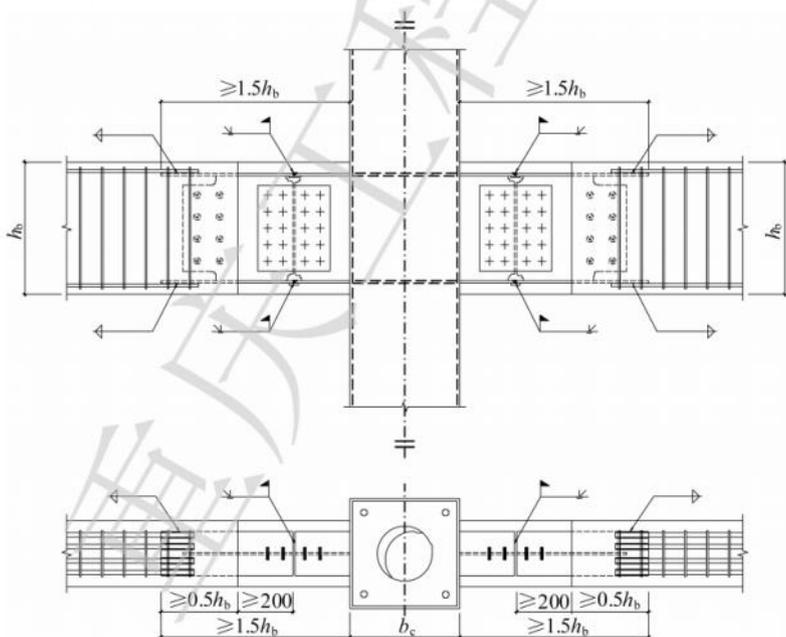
预制混凝土梁-钢管混凝土柱带牛腿内隔板式连接节点
